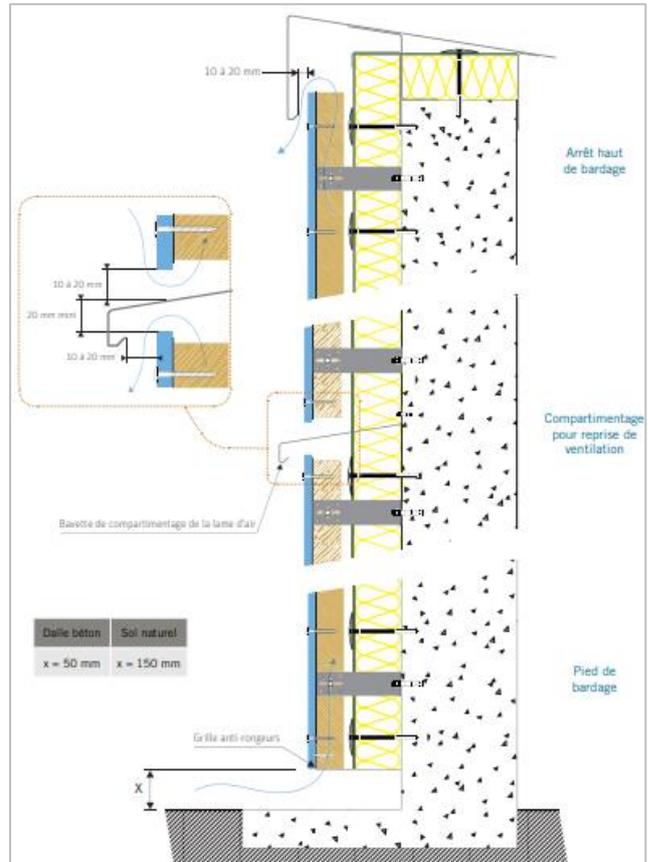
Fixation d'un panneau HPL sur ossature porteuse en béton
